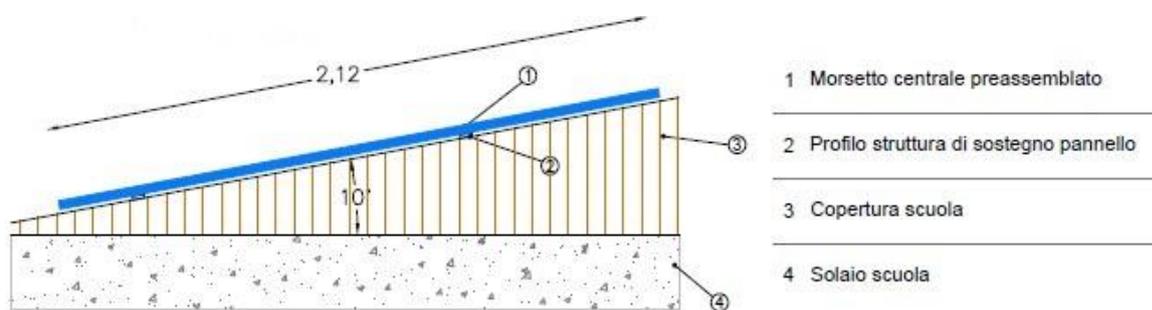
Vista posizionamento inclinazione pannelli fotovoltaici scuola
